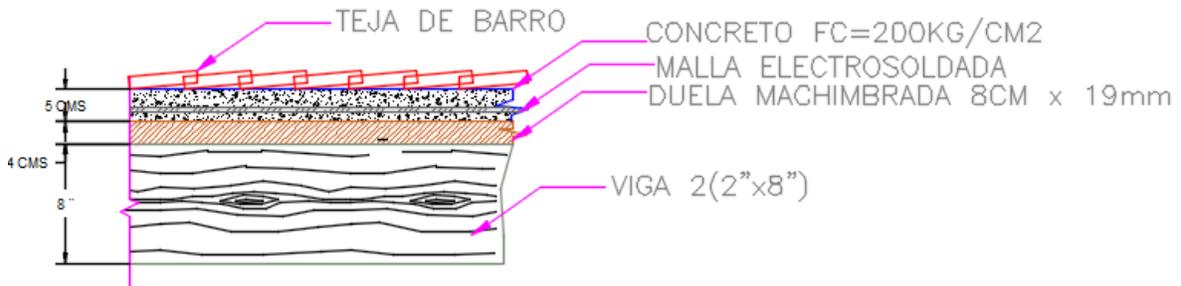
Detalle 4 de Cubierta en machimbre, elaboración propia
